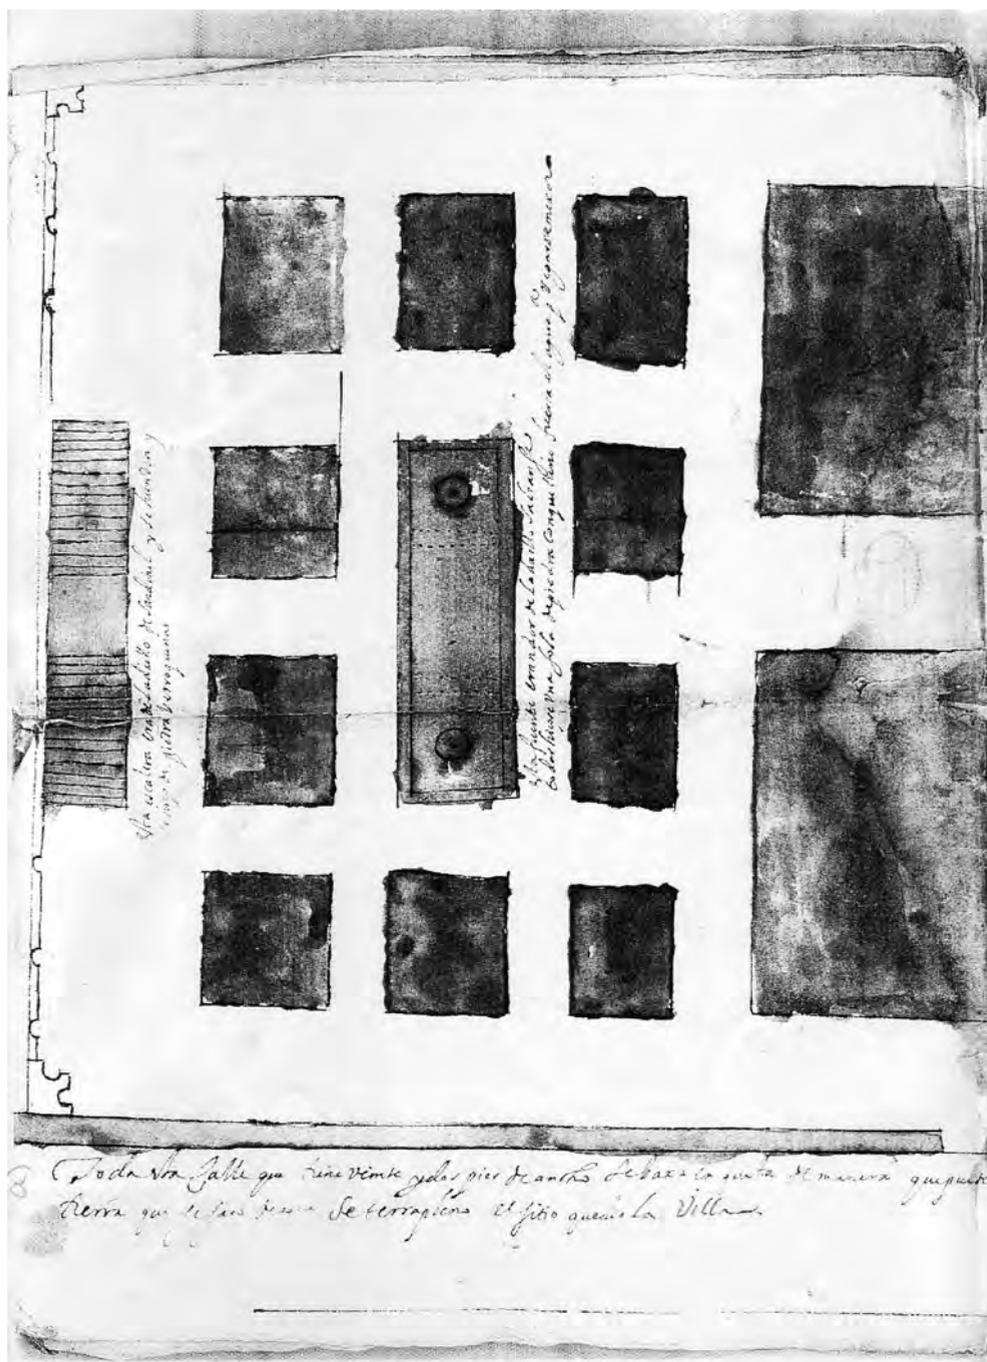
Palacio de Buenavista - Plano del jardín con las fuentes en primer plano [AHPZ: Híjar, 4^a-276-1].
